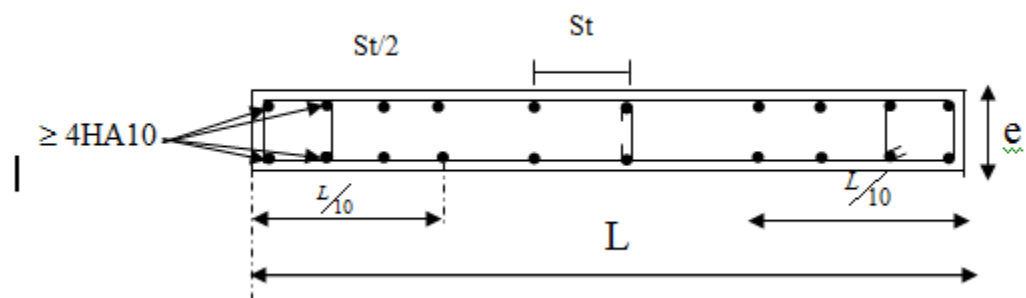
Disposition des armatures verticales dans les voiles.
